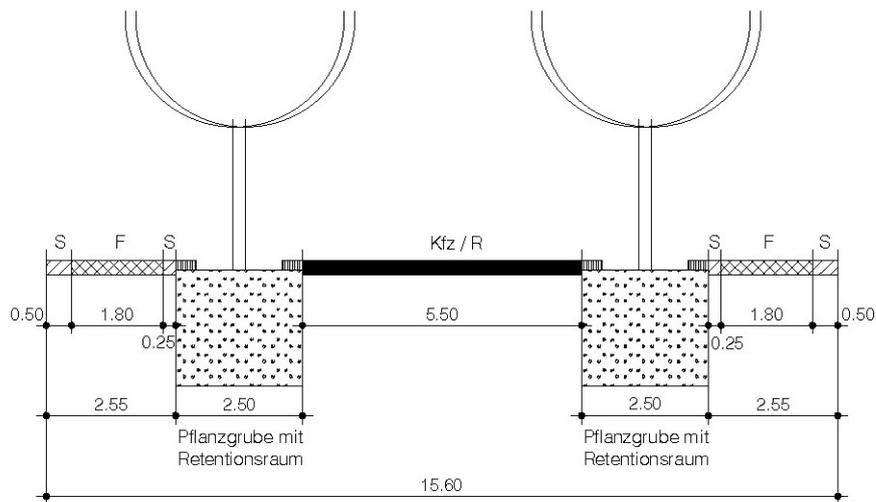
empfohlener Straßenquerschnitt für die Planstraßen „B“ und „D“
